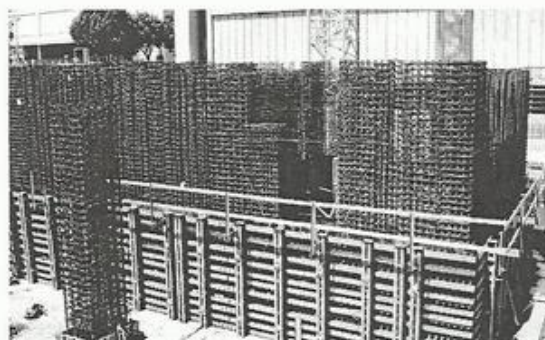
Confinamiento abundante en las columnas y muros del primer piso de un rascacielos a construirse en Los Ángeles.
